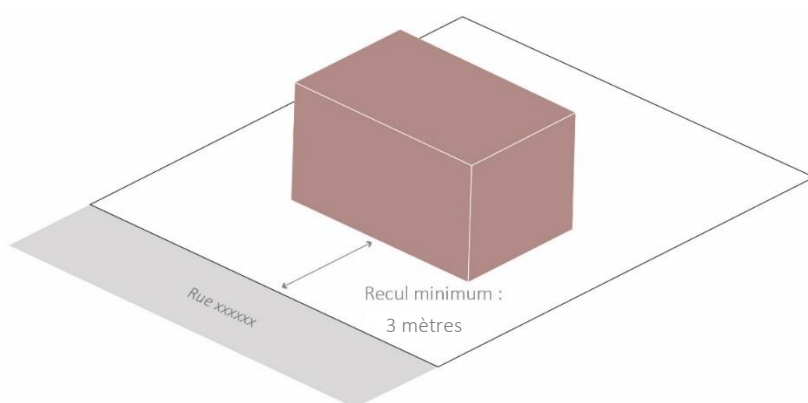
\_ Implantation des nouvelles constructions par rapport à l'alignement
